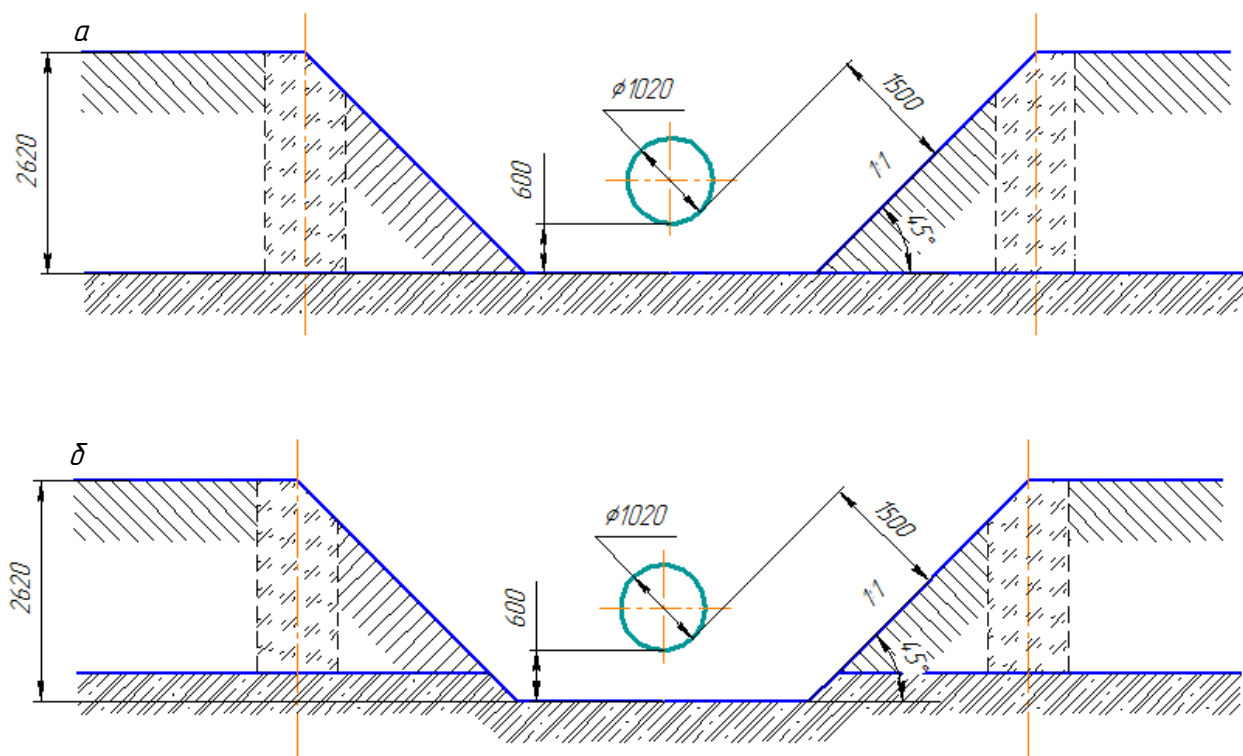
Поперечный разрез котлована и ледогрунтового ограждения
